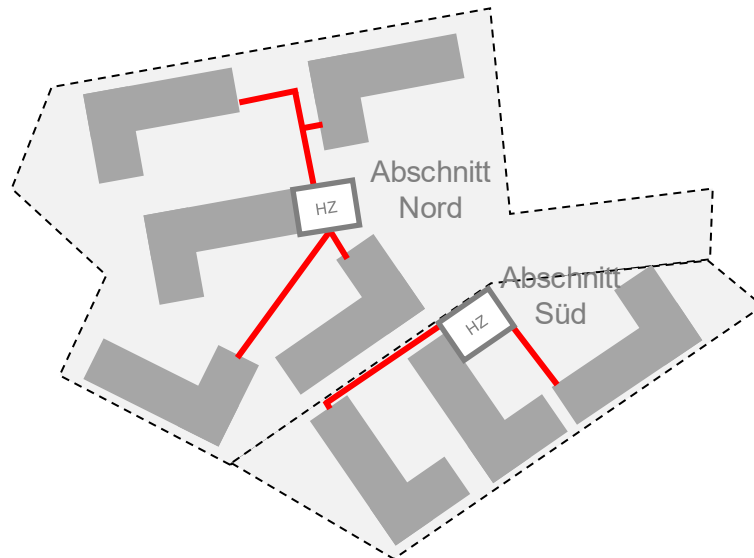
Möglicher Lageplan des Nahwärmenetzes
